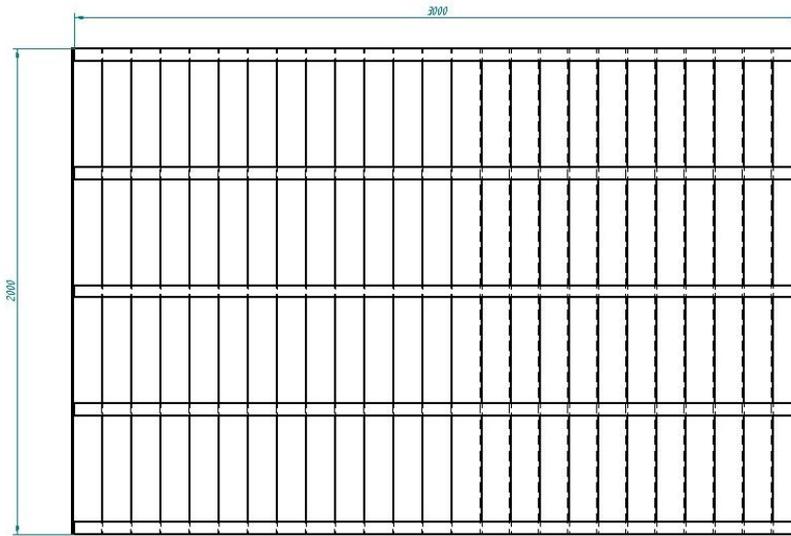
Plano panel piso derecho de la vivienda de emergencia de Un Techo Para Mi País
